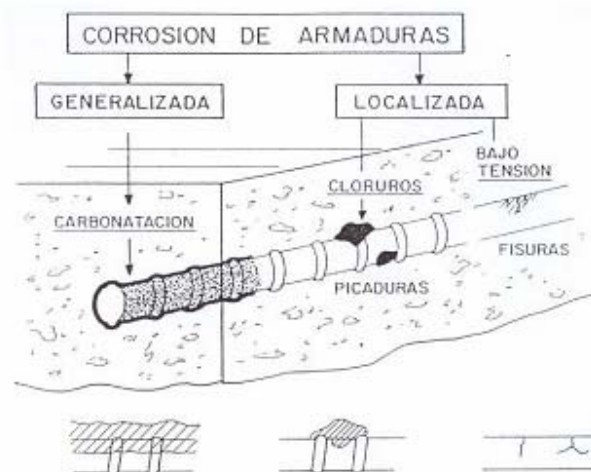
Tipos de corrosión de armaduras en el hormigón [8].
